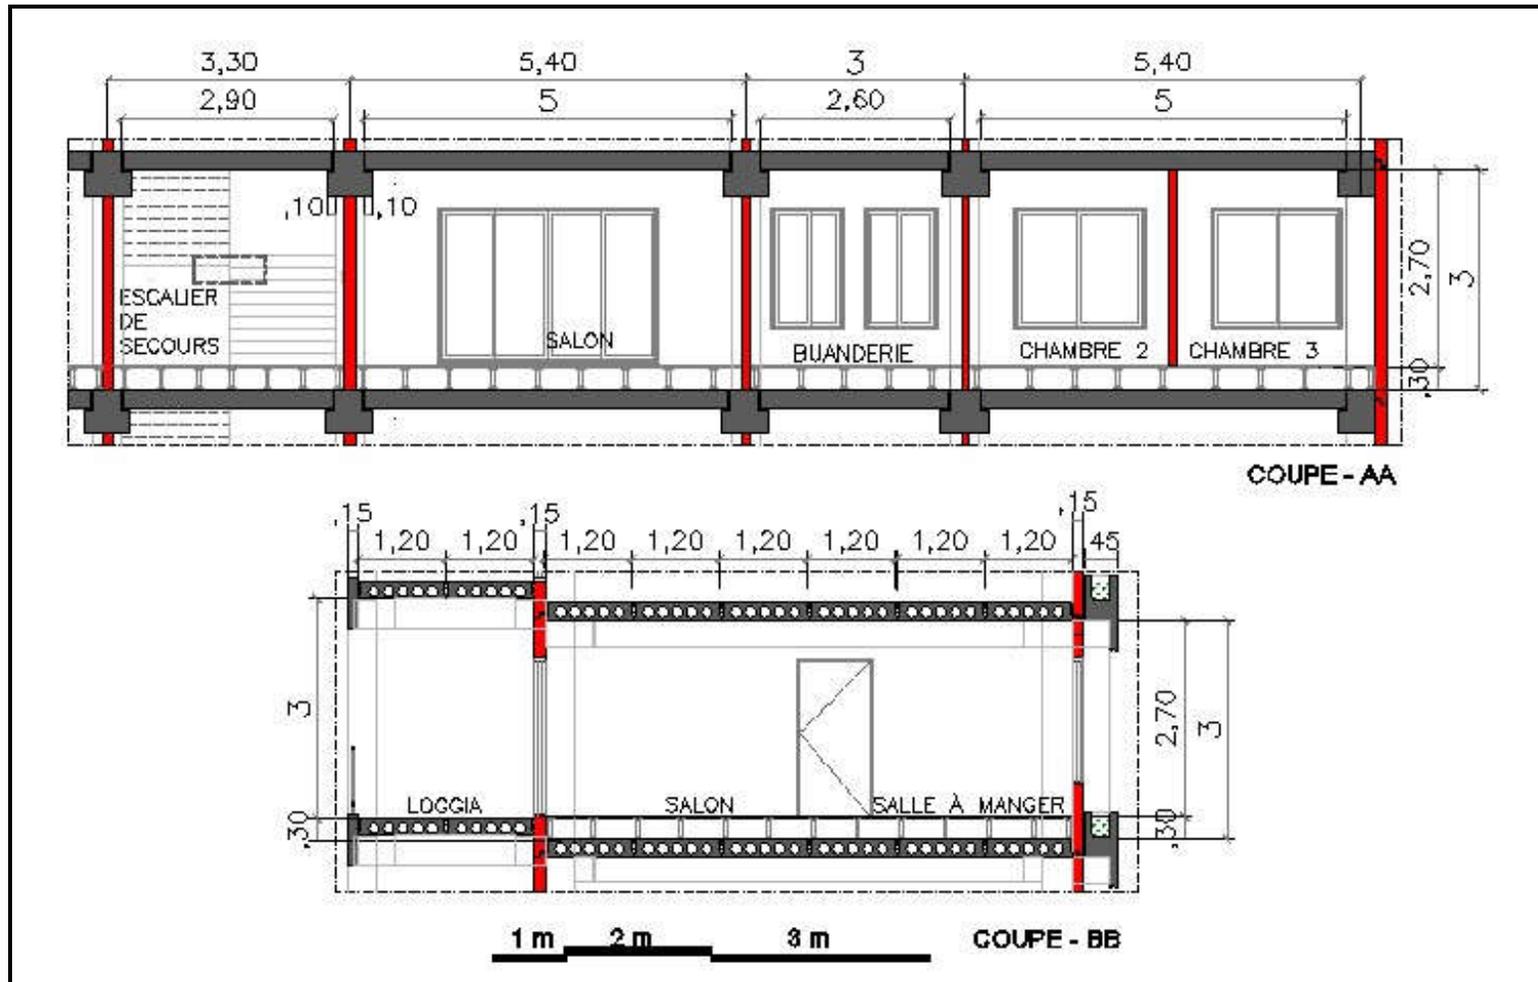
Coupes AA et BB appliquées au système de poutres et colonnes
